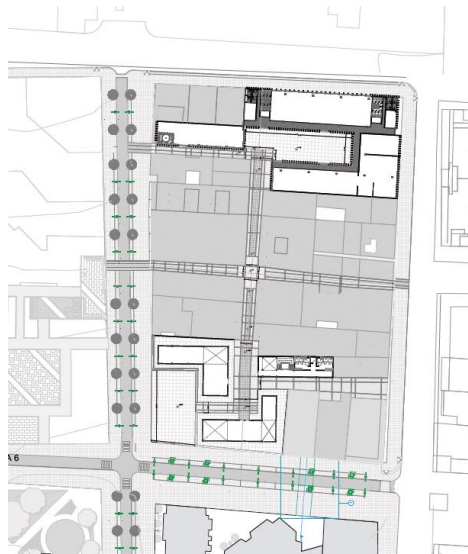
Planta de propuesta manzana 16, Fuente: elaboración en grupo manzana 16
